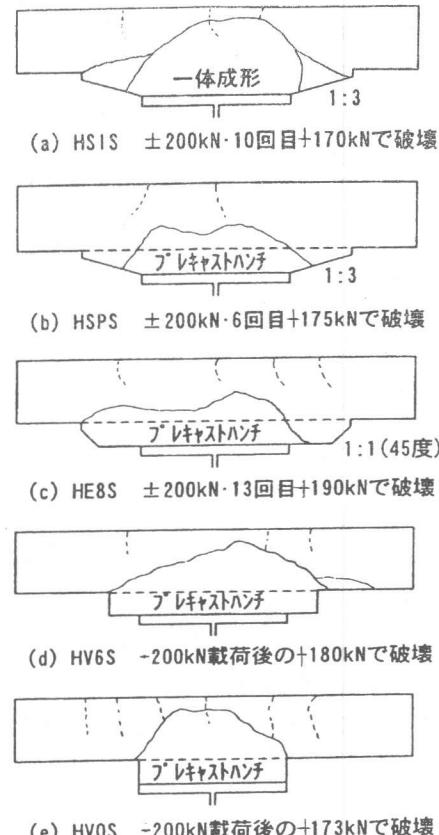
破壊荷重とコンクリートのひび割れ性状
